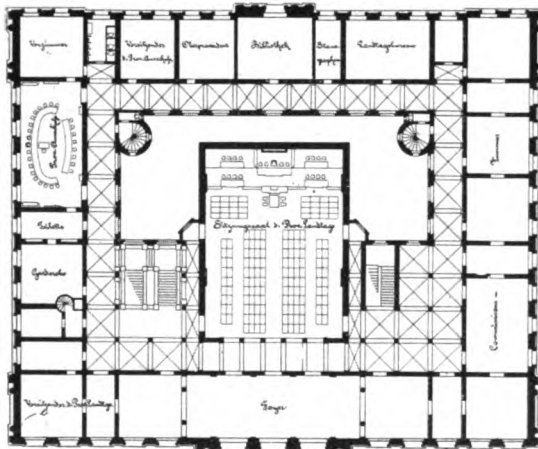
Grundriss des 1. Stockwerks. 1 : 800.
